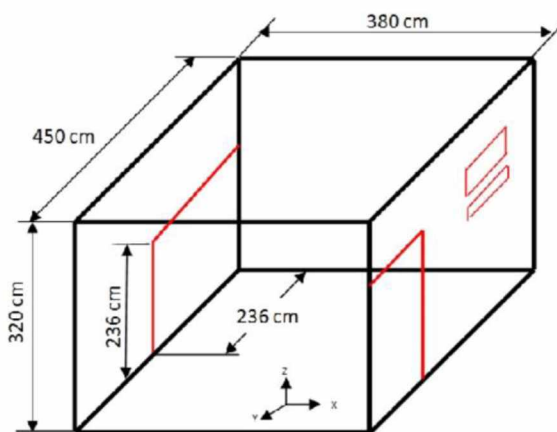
3d схема произвольного помещения, где планируется произвести расчет тепла
